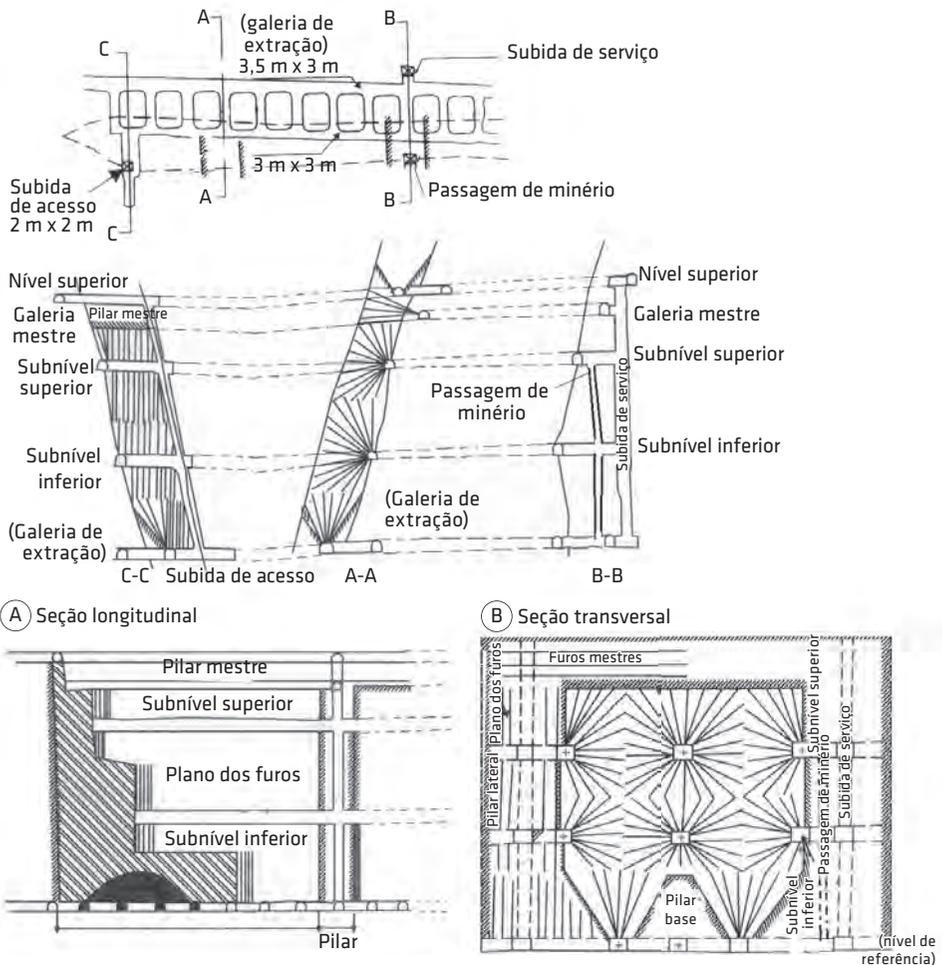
(A) Lavra por subnível longitudinal e (B) lavra por subnível transversal
